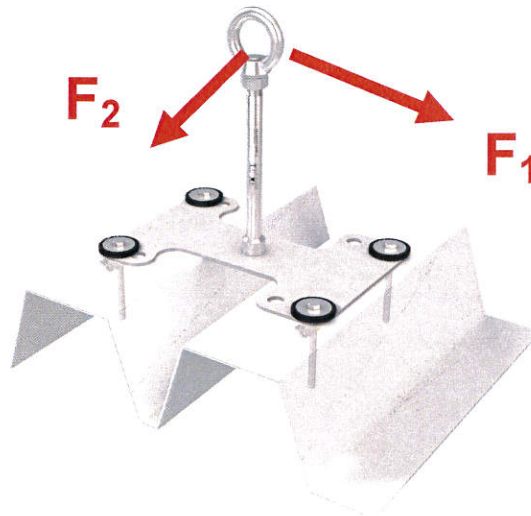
Anschlagereinrichtung, Typ: ABS-Lock® X-T-21 mit den Richtungen der Kräfteinleitung (Montage auf Trapezprofil)
